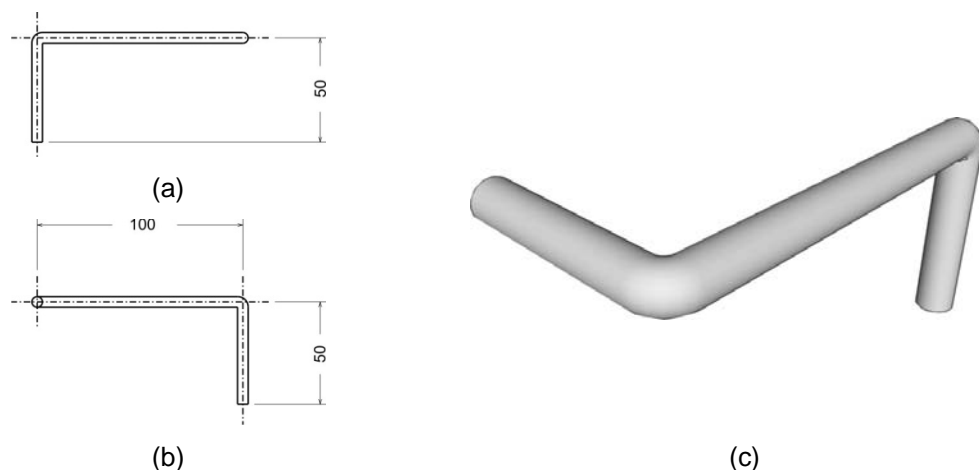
Detalhe dos fios de conexão (dimensões em milímetro)
